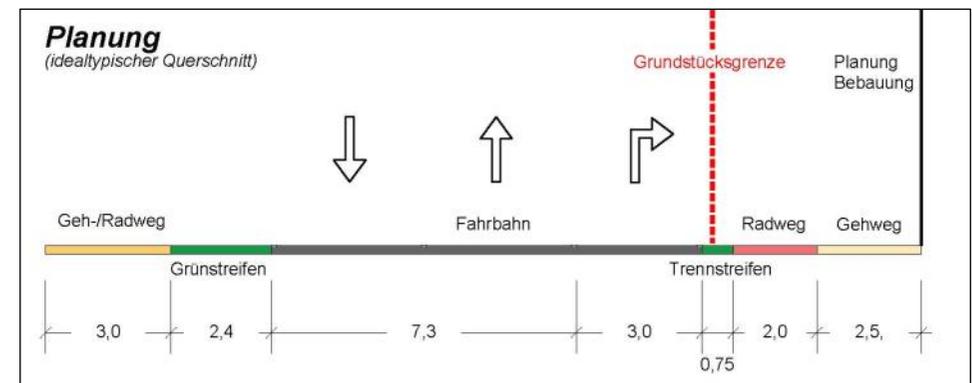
Planung Querschnitt, Kaiserswerther Straße
